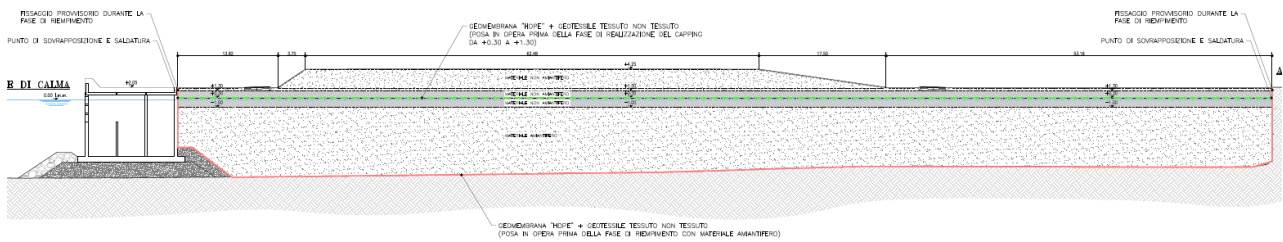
Sezione tipologica con individuazione della posa in opera della geomembrana HDPE + geotessile tessuto non tessuto
